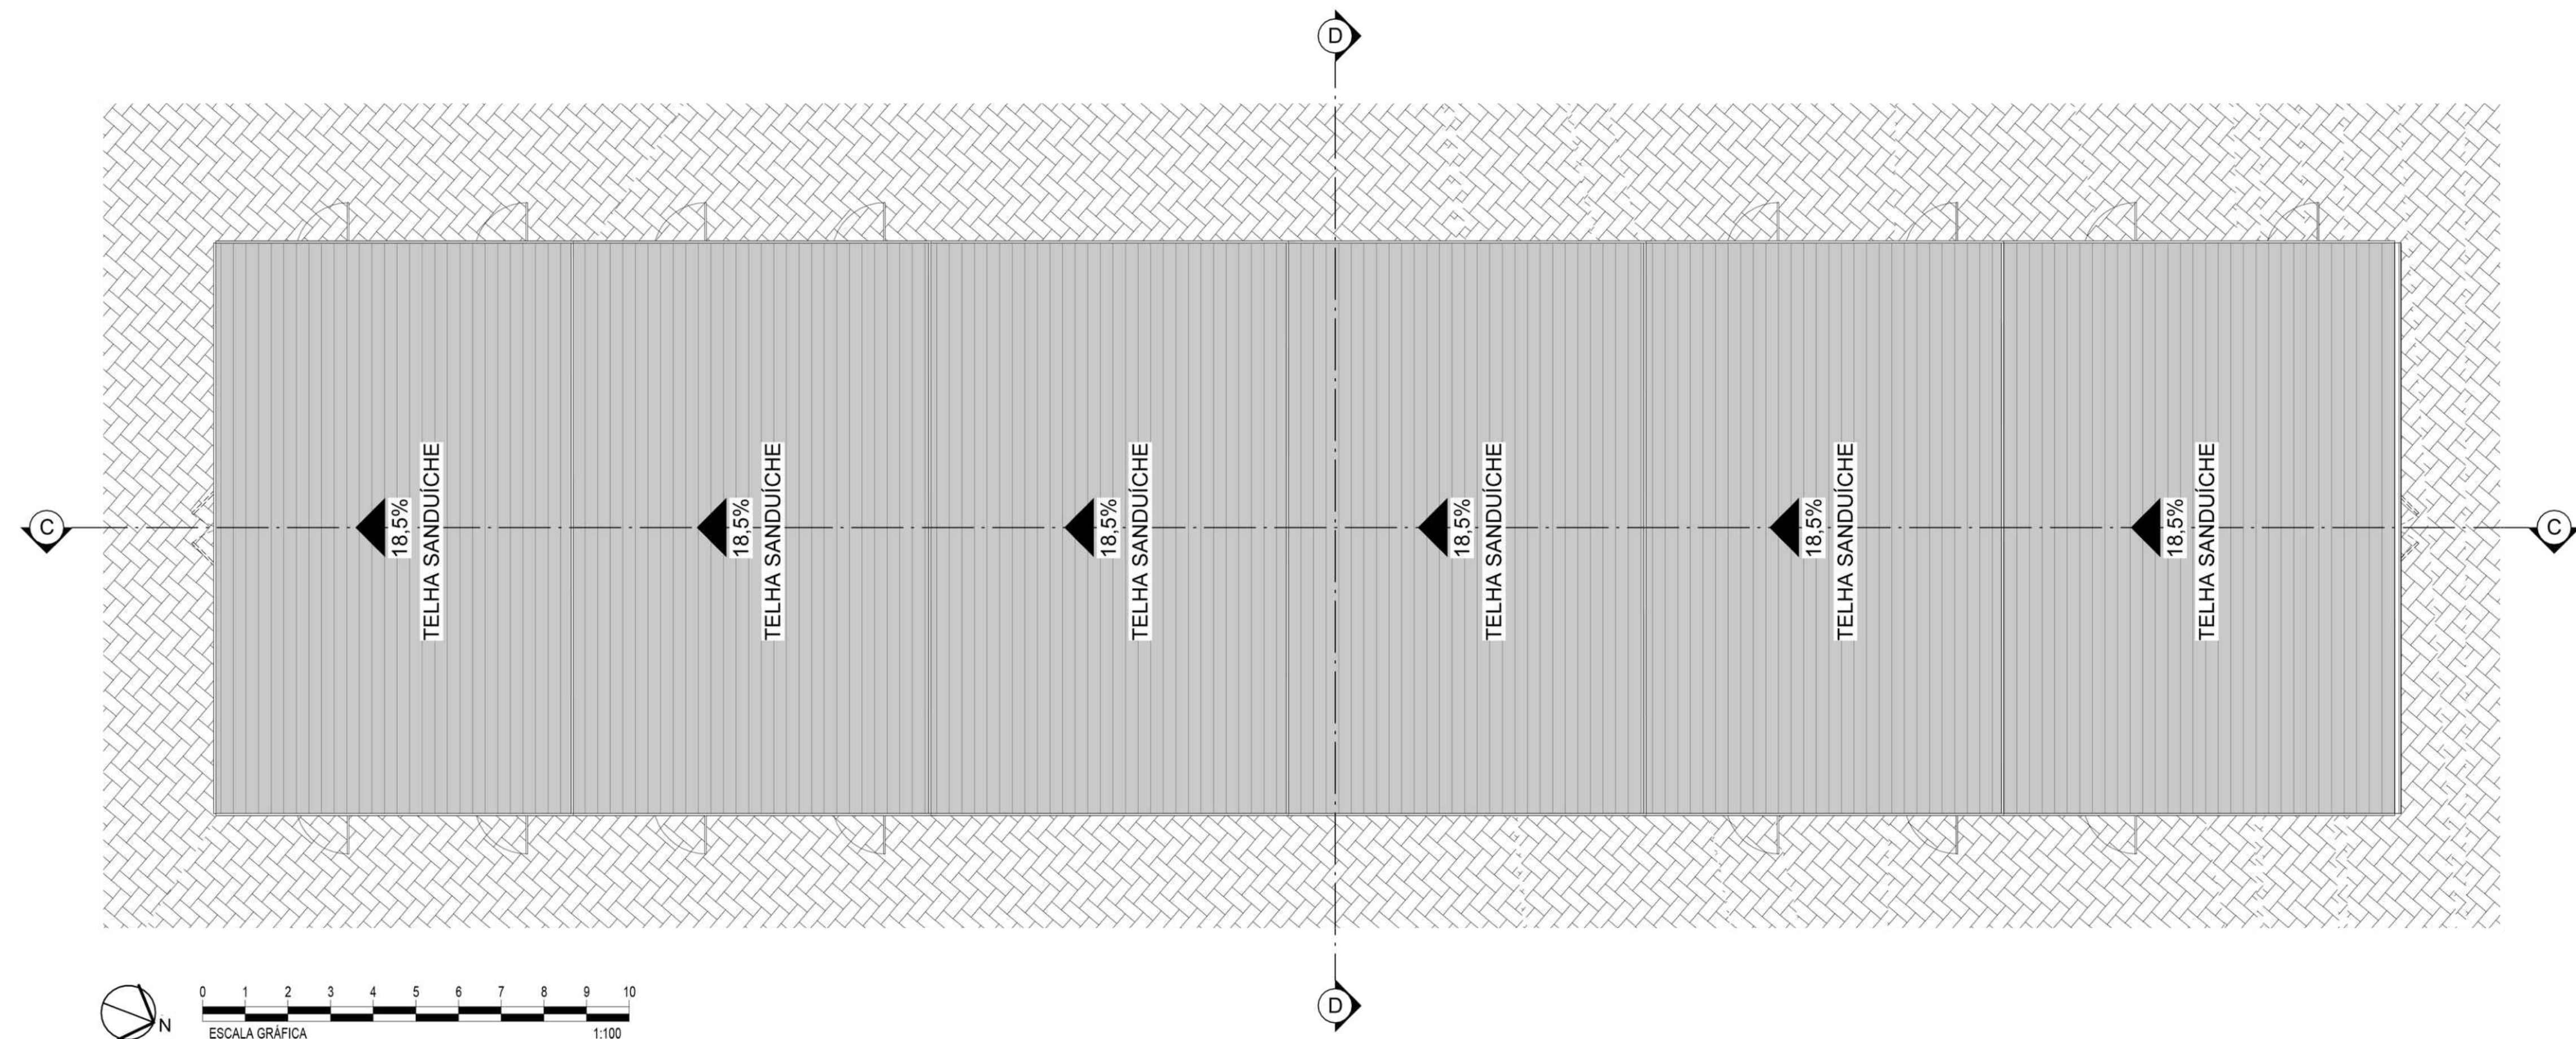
Planta de cobertura pavilhão tipo Fonte: Autora (2024)
